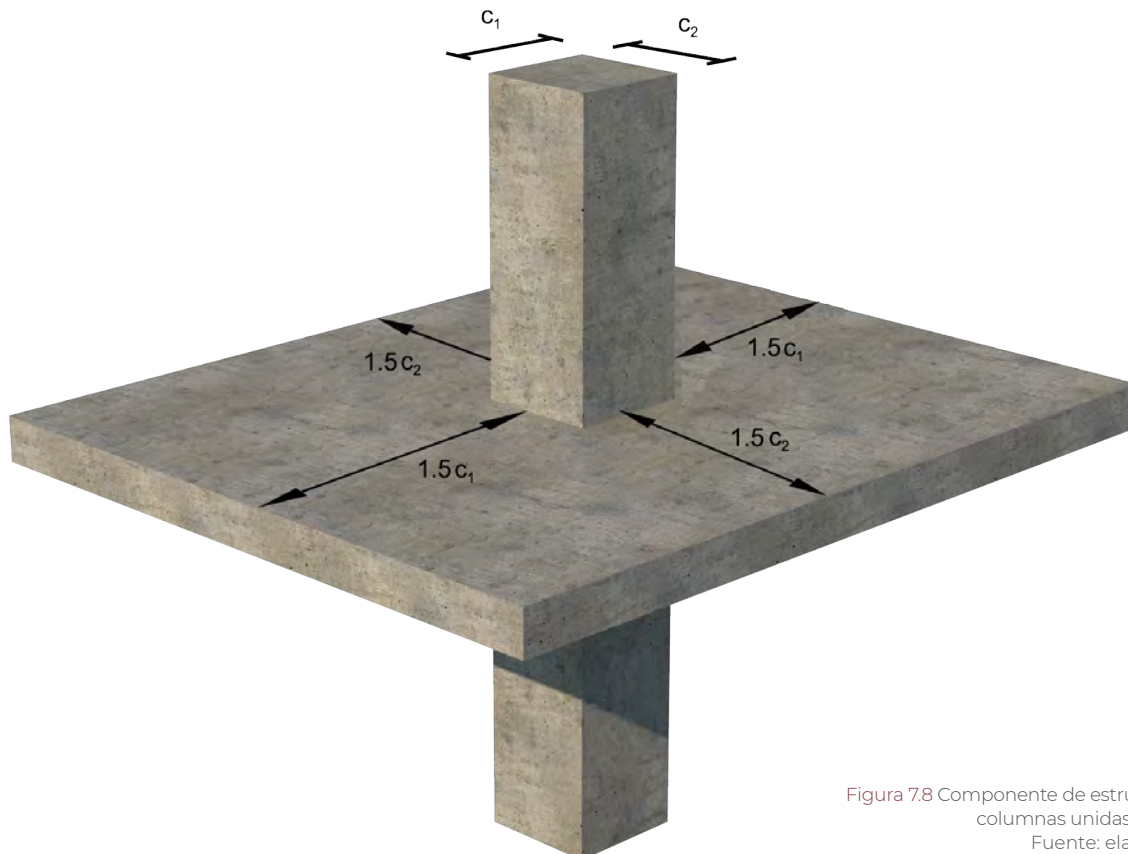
Componente de estructuras a base de columnas unidas por losas planas.
